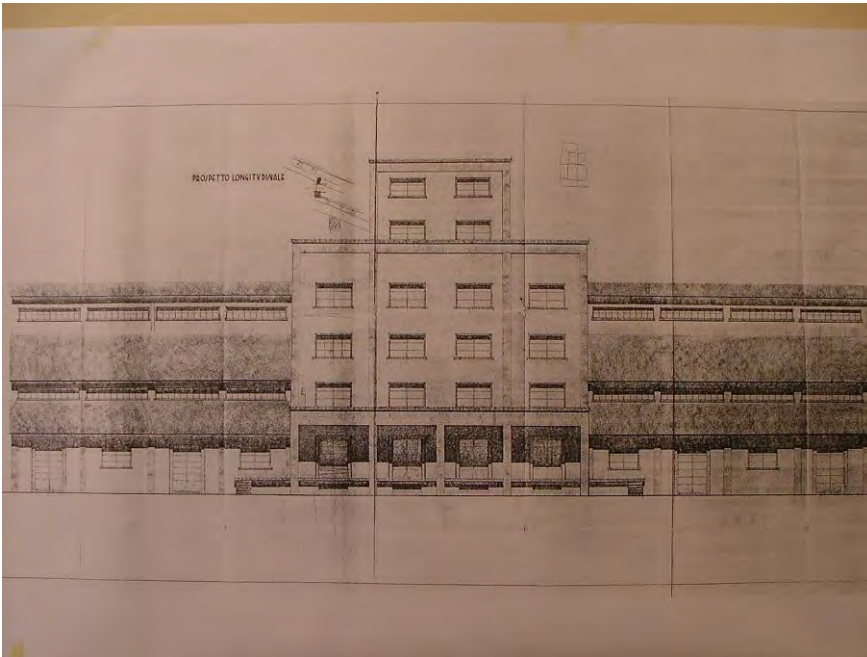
Progetto Nervi, prospetto laterale, 1954
